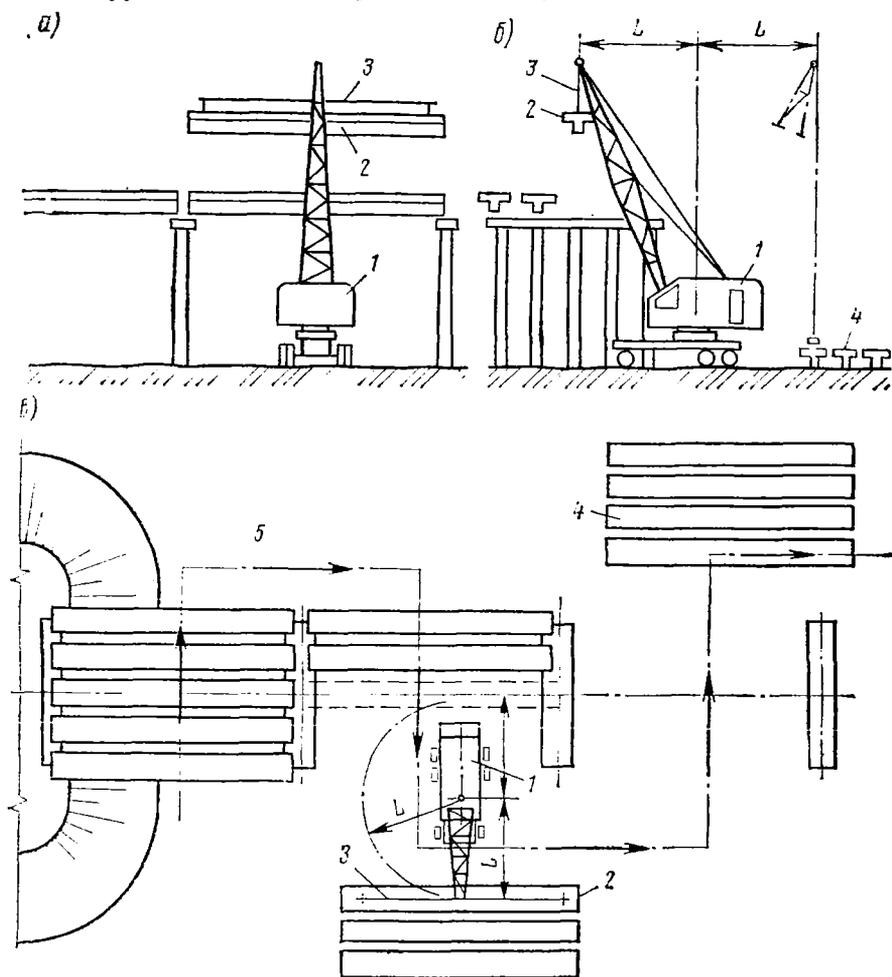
Схема монтажа пролетных строений стреловым краном сбков:
